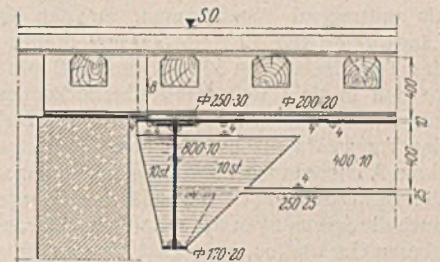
Längsschnitt a-a neben der Längsrippe am Auflager.
